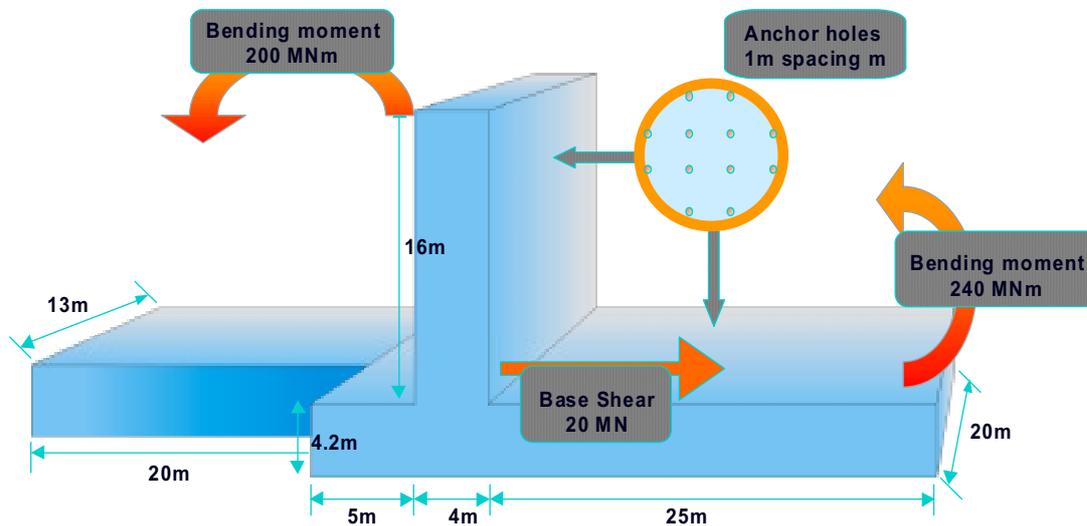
Il muro di reazione presso il laboratorio ELSA.
